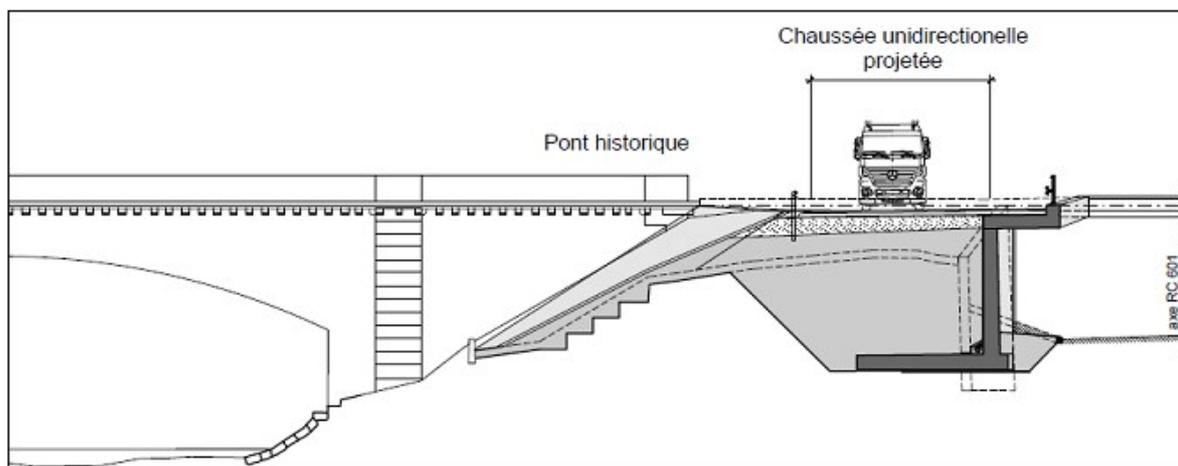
Nouvelle bretelle, profil en travers n° 1
